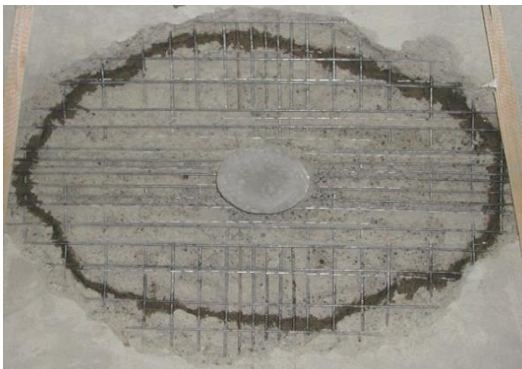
Rissbildung entlang der Enden des Einbauteiles
